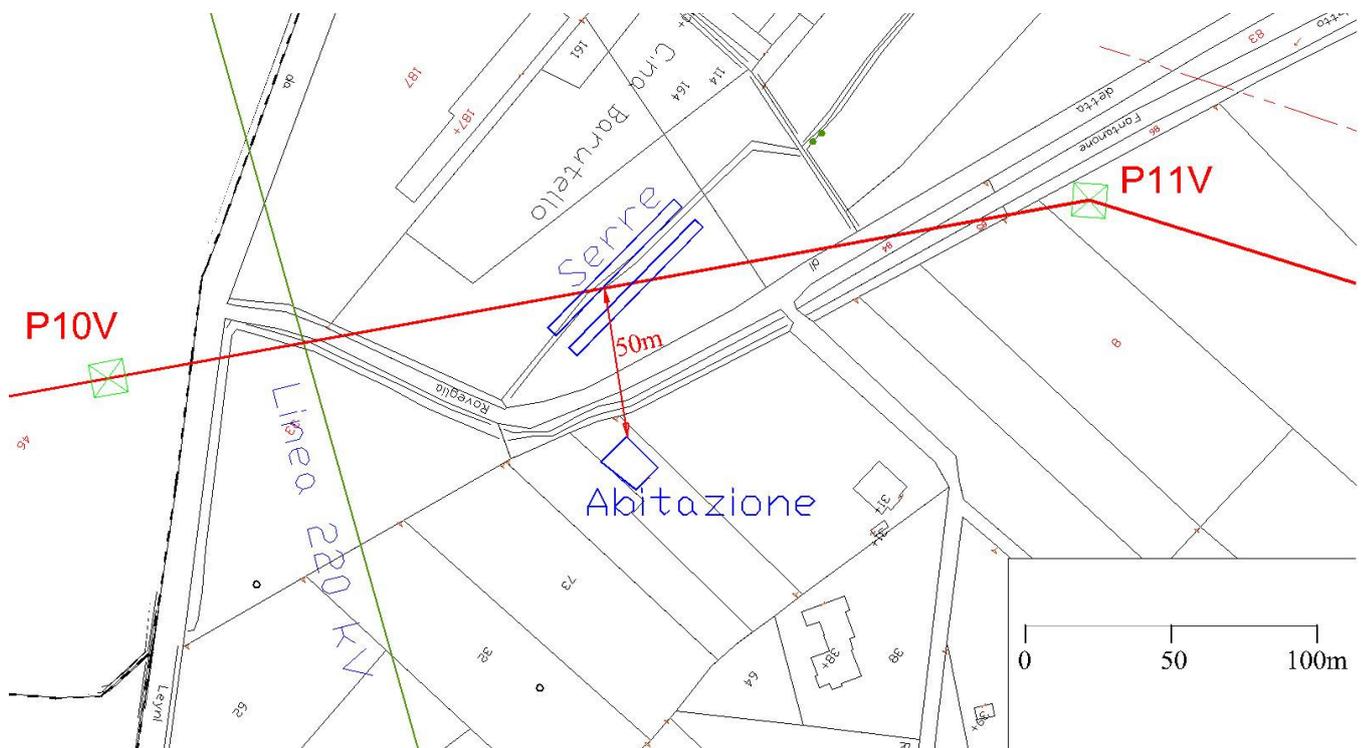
planimetria dell'area oggetto dell'intervento
